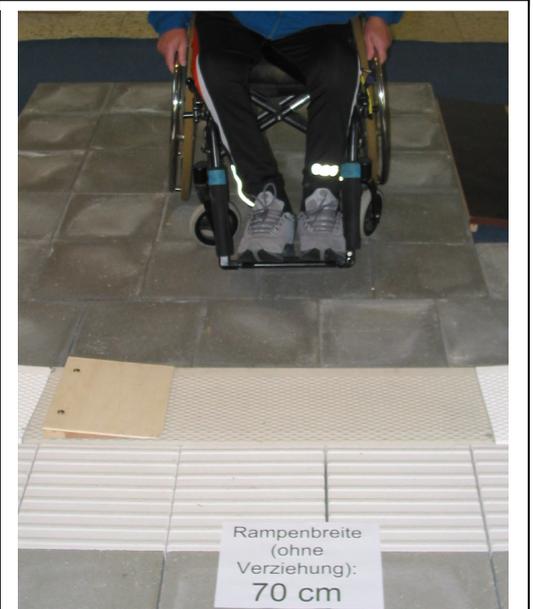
30: Versuche mit einer Testrampe mit variabler Breite zeigten, dass auch Rampen mit weniger als 90 cm Breite bewältigt würden.
